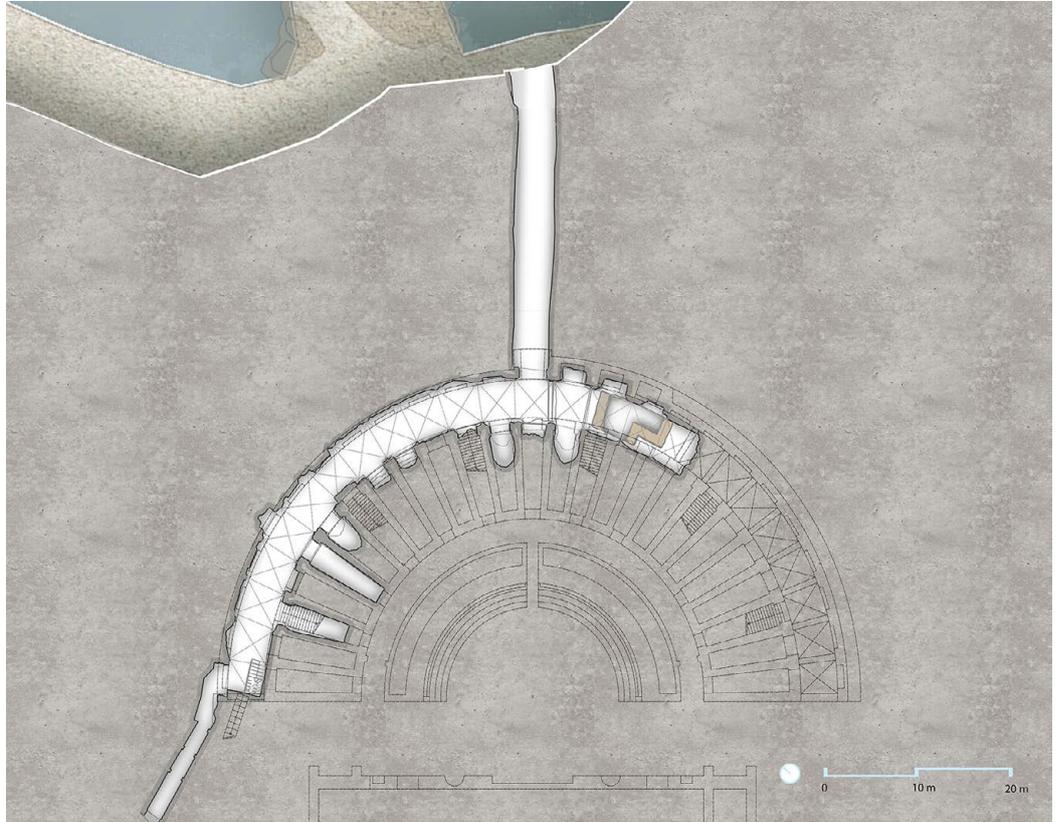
Planimetria del Teatro di Miseno con ricostruzione. Elaborazione di Alessandra Coppola.
